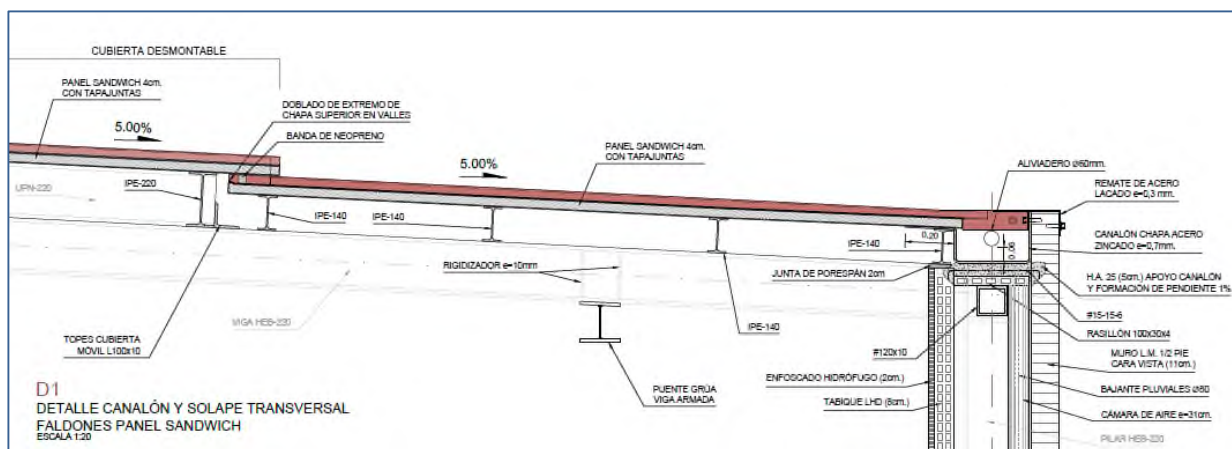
Cubierta tipo sándwich sobre correas metálicas
